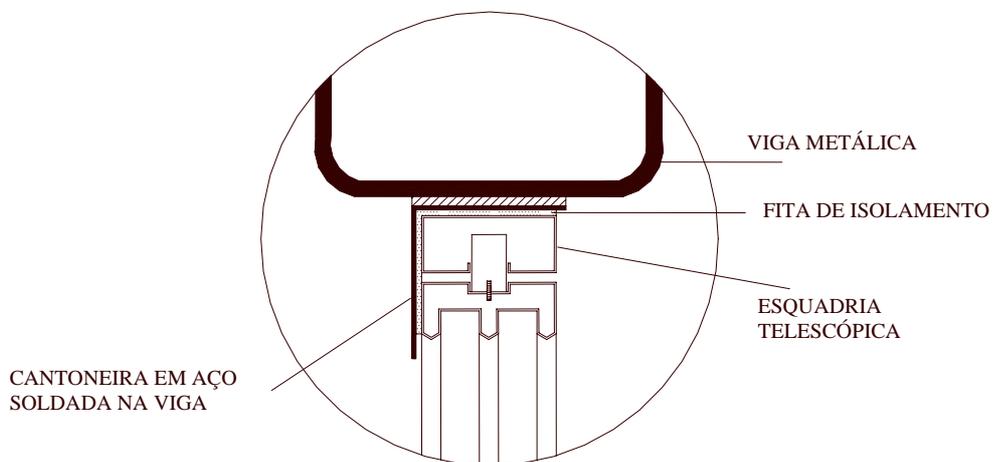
Detalhe 1: interface entre a esquadria e viga metálica.
